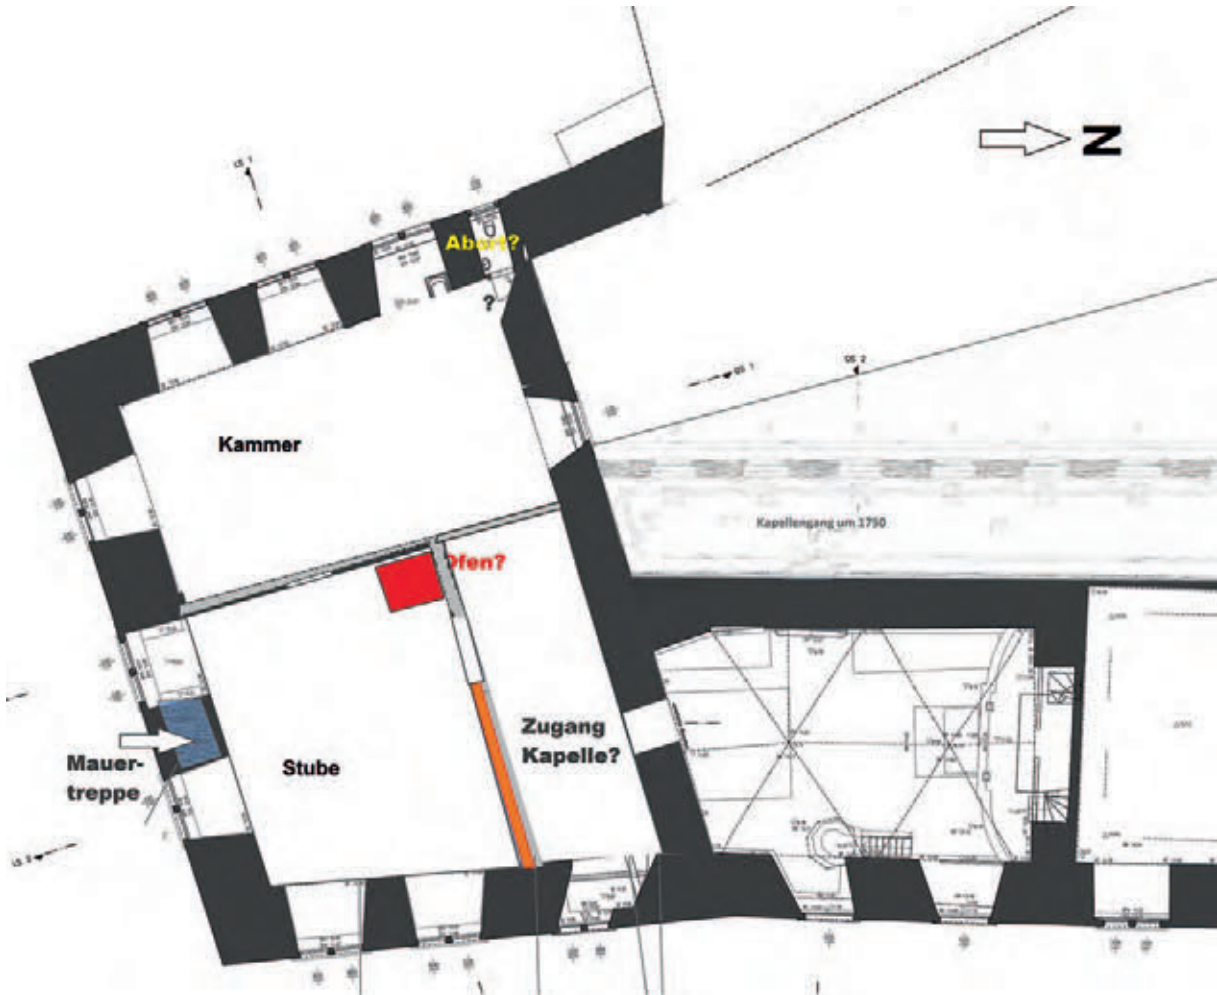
Kemenate, 2. Obergeschoss. Hypothetische Rekonstruktion des ursprünglichen Grundrisses.
